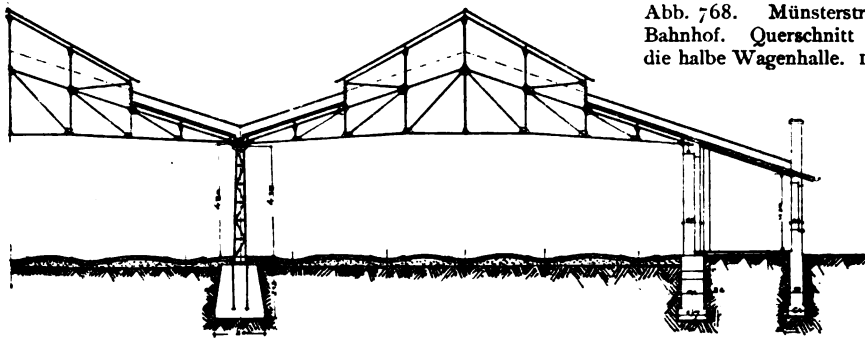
Münsterstrassen-Bahnhof. Querschnitt durch die halbe Wagenhalle. 1:300.
